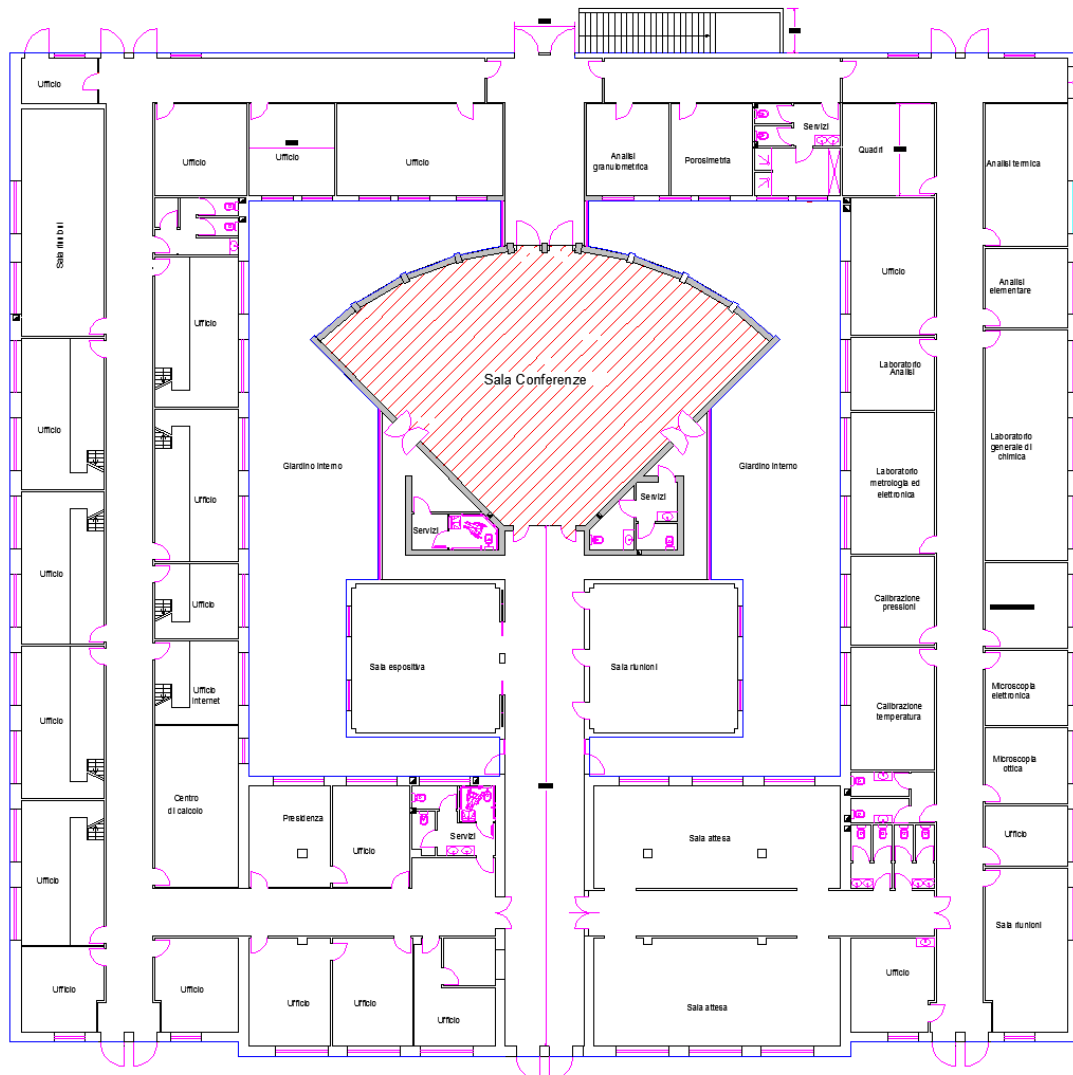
Pianta dell'edificio (Frau et al., 2016).
